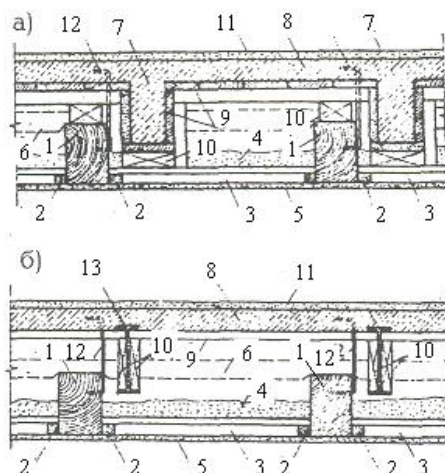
Устройство негорючего перекрытия при частичном или полном сохранении исторического деревянного перекрытия:
